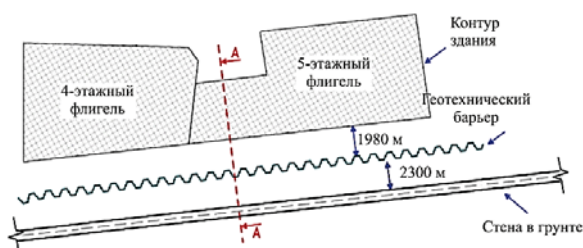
Схема расположение здания относительно геотехнического барьера и конструкции «стена в грунте»
